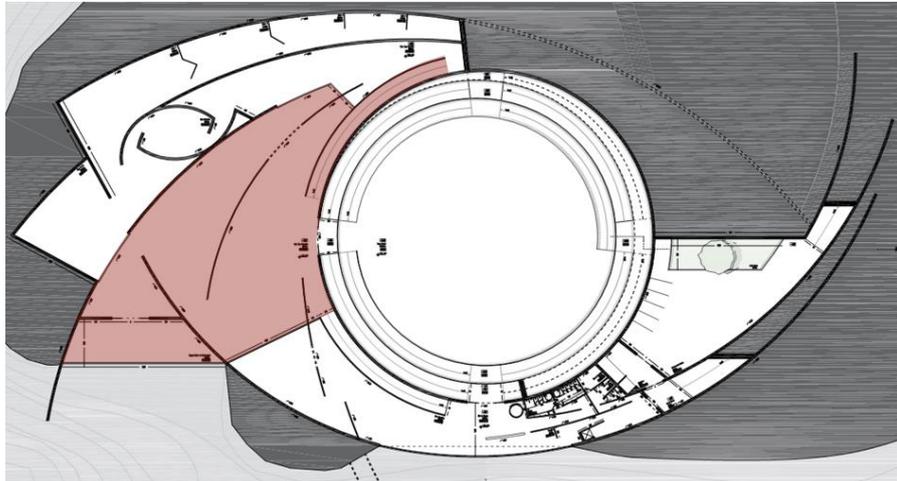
Planta do piso -2: continuação da zona expositiva.
